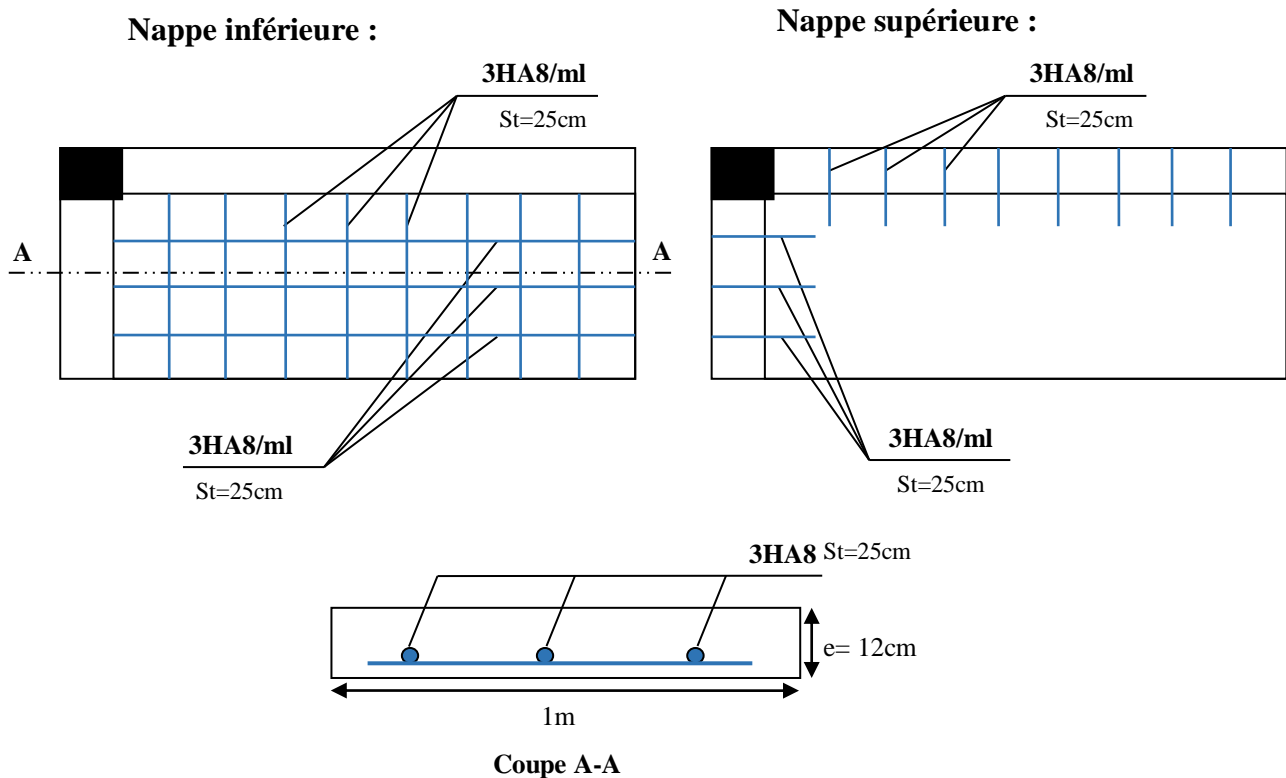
Schéma de ferrailage de panneau de dalle D2, D3 et D4
